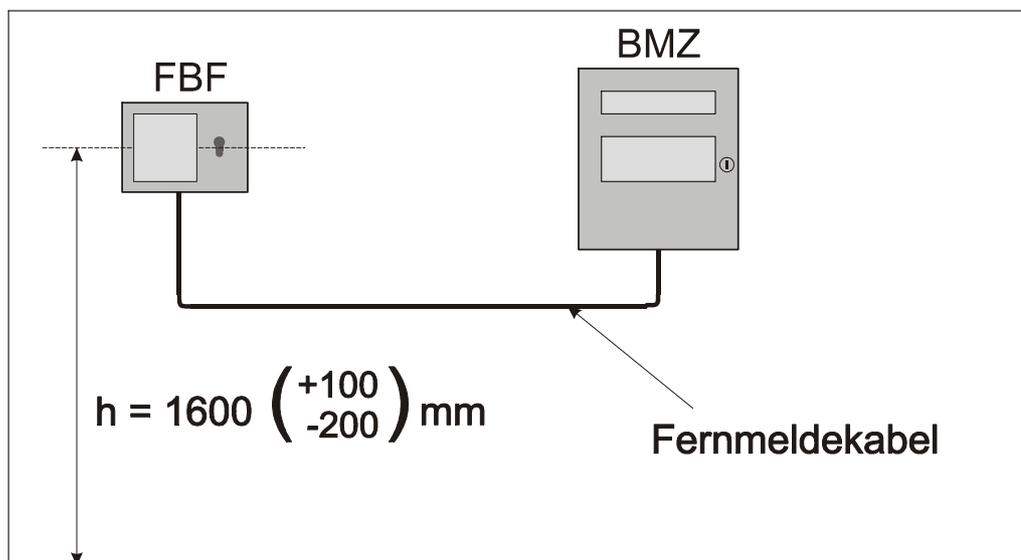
Montageskizze ( Maße gemäß DIN 14661 )
